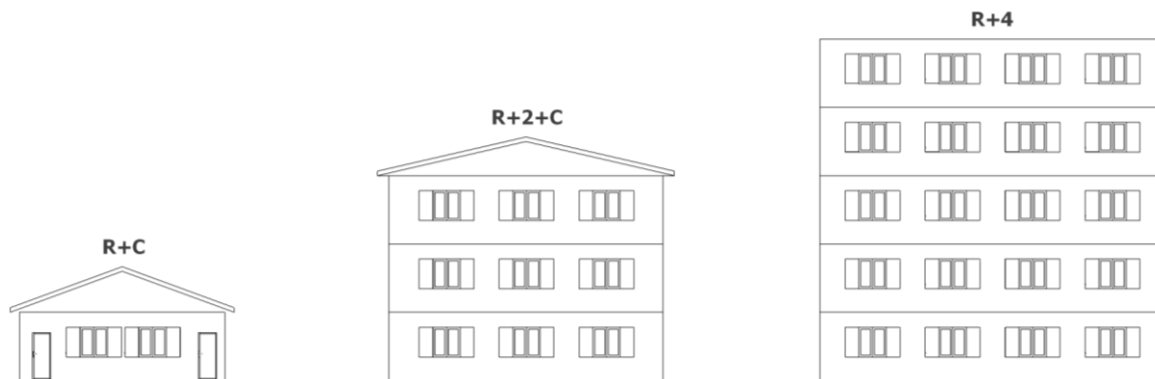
Quelques exemples de logements collectifs ou intermédiaires
